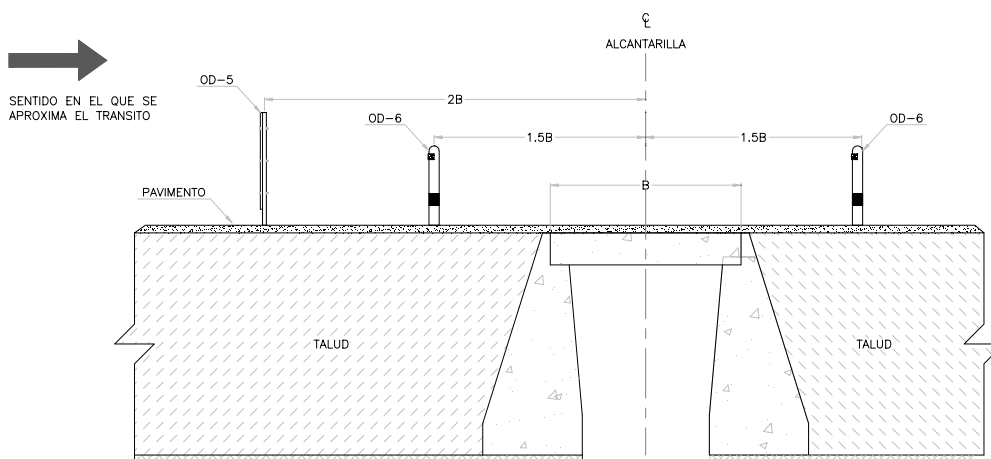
Disposición de señalamiento en Alcantarillas
